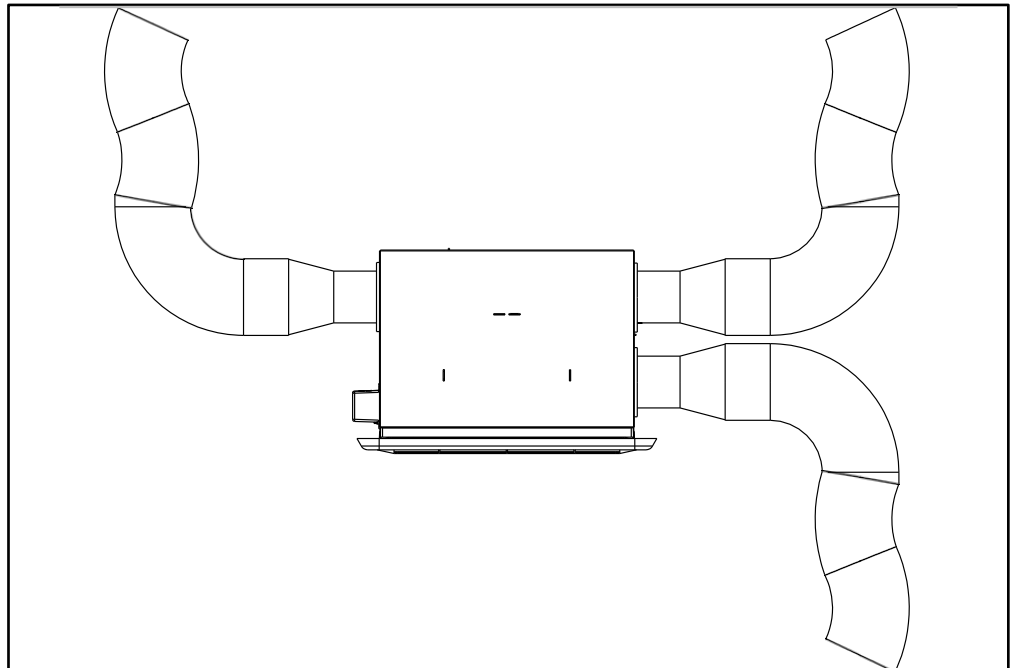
INSTALLATION DES CONDUITS FLEXIBLES
